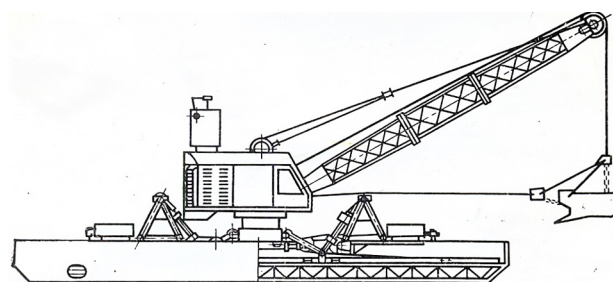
Экспериментальный образец шагающего экскаватора конструкции СибНИПИгазстроя [10]
